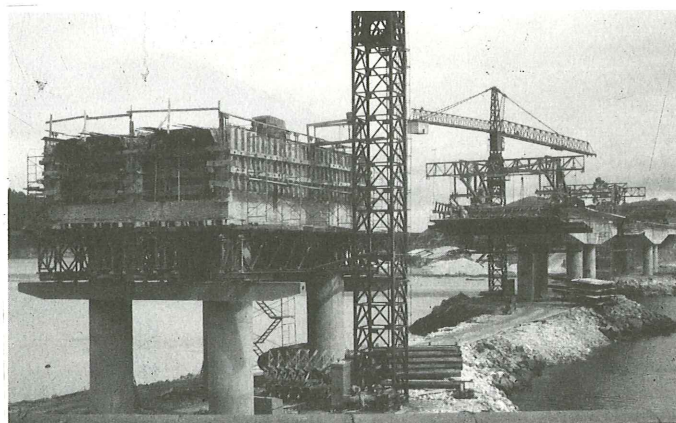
Vista de las tres fases del tablero: "In situ", voladizo y vigas prefabricadas.
